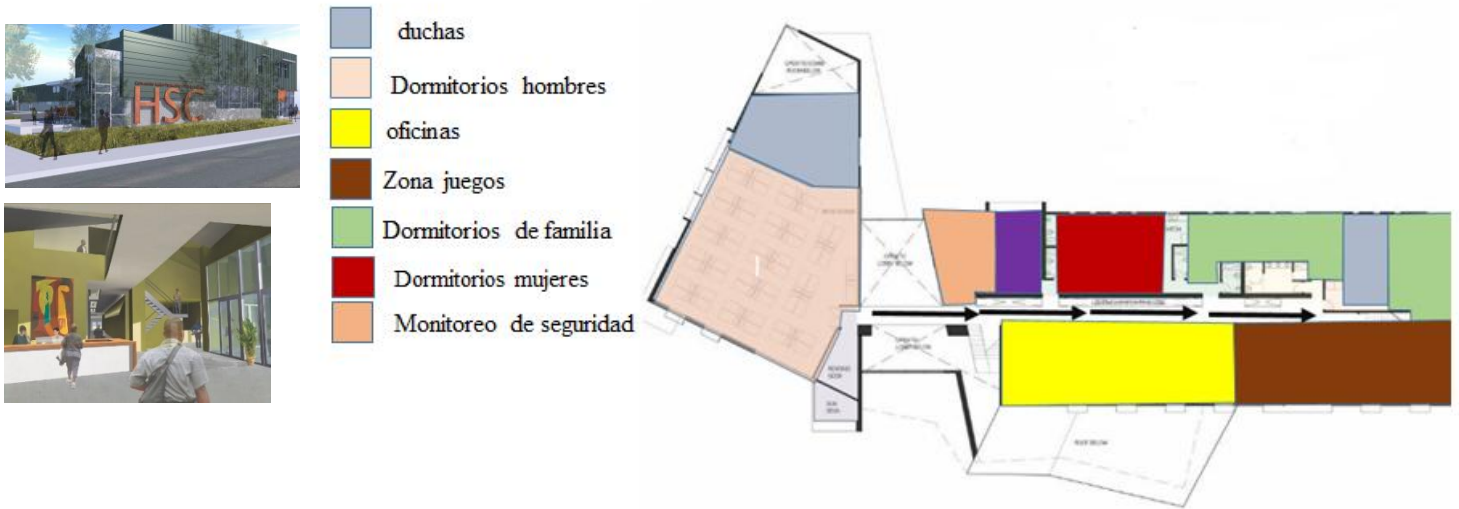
Planta primer piso Vivienda San Luis Obispo. Fuente: San Luis Obispo
